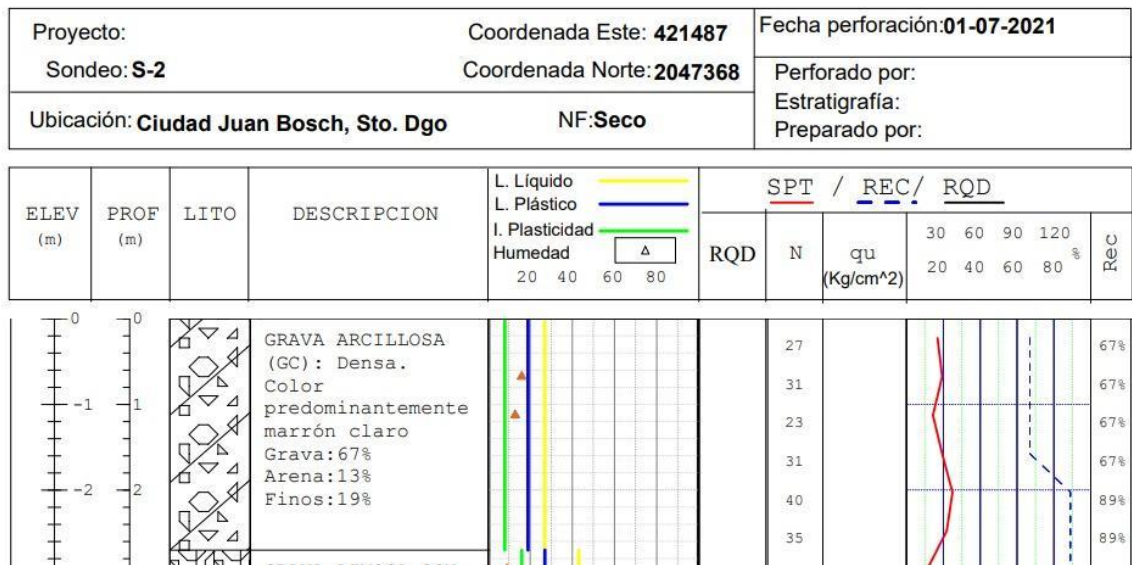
Sondeo 2 de Informe geotécnico para la construcción de planta de aguas residuales en fase II Ciudad Juan Bosch, Santo Domingo Este.
